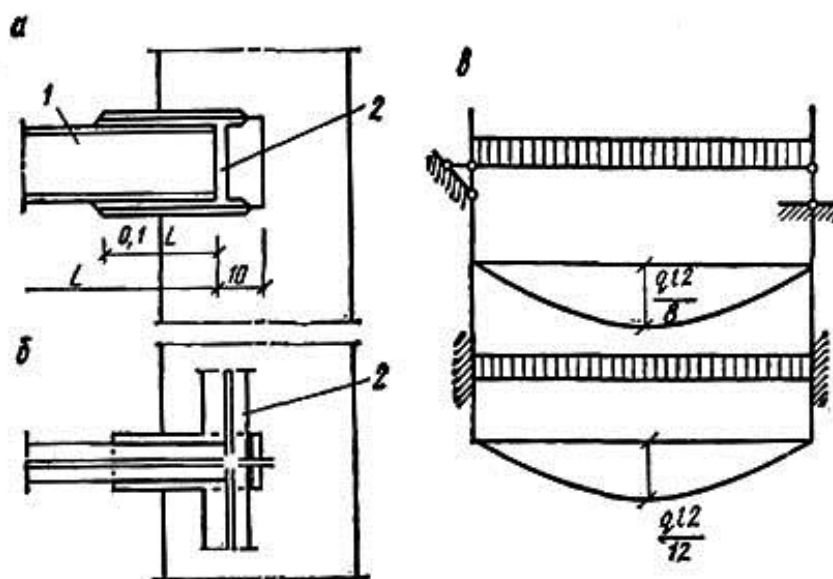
Превращение шарнирной опоры в жесткую: а – фасад; б – план; в – расчетная схема; 1 – существующая балка; 2 – анкер
